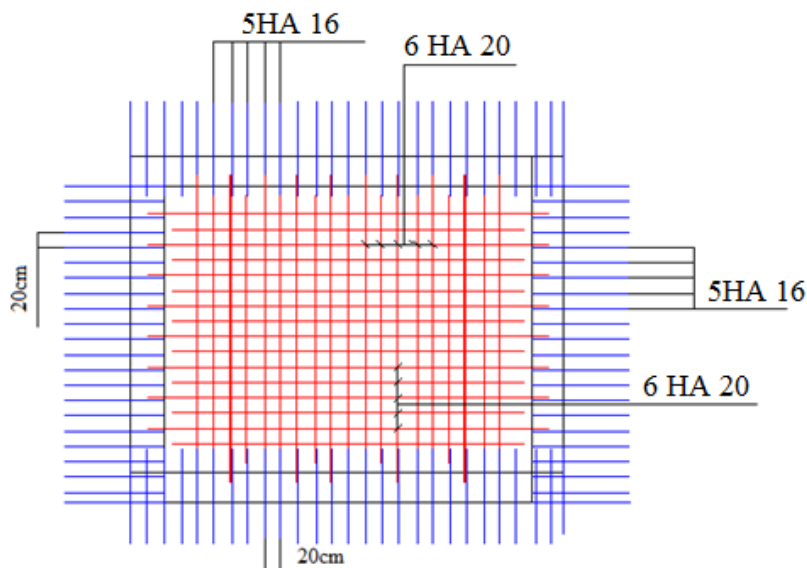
Schémas de ferrailage du mur soutènement.
